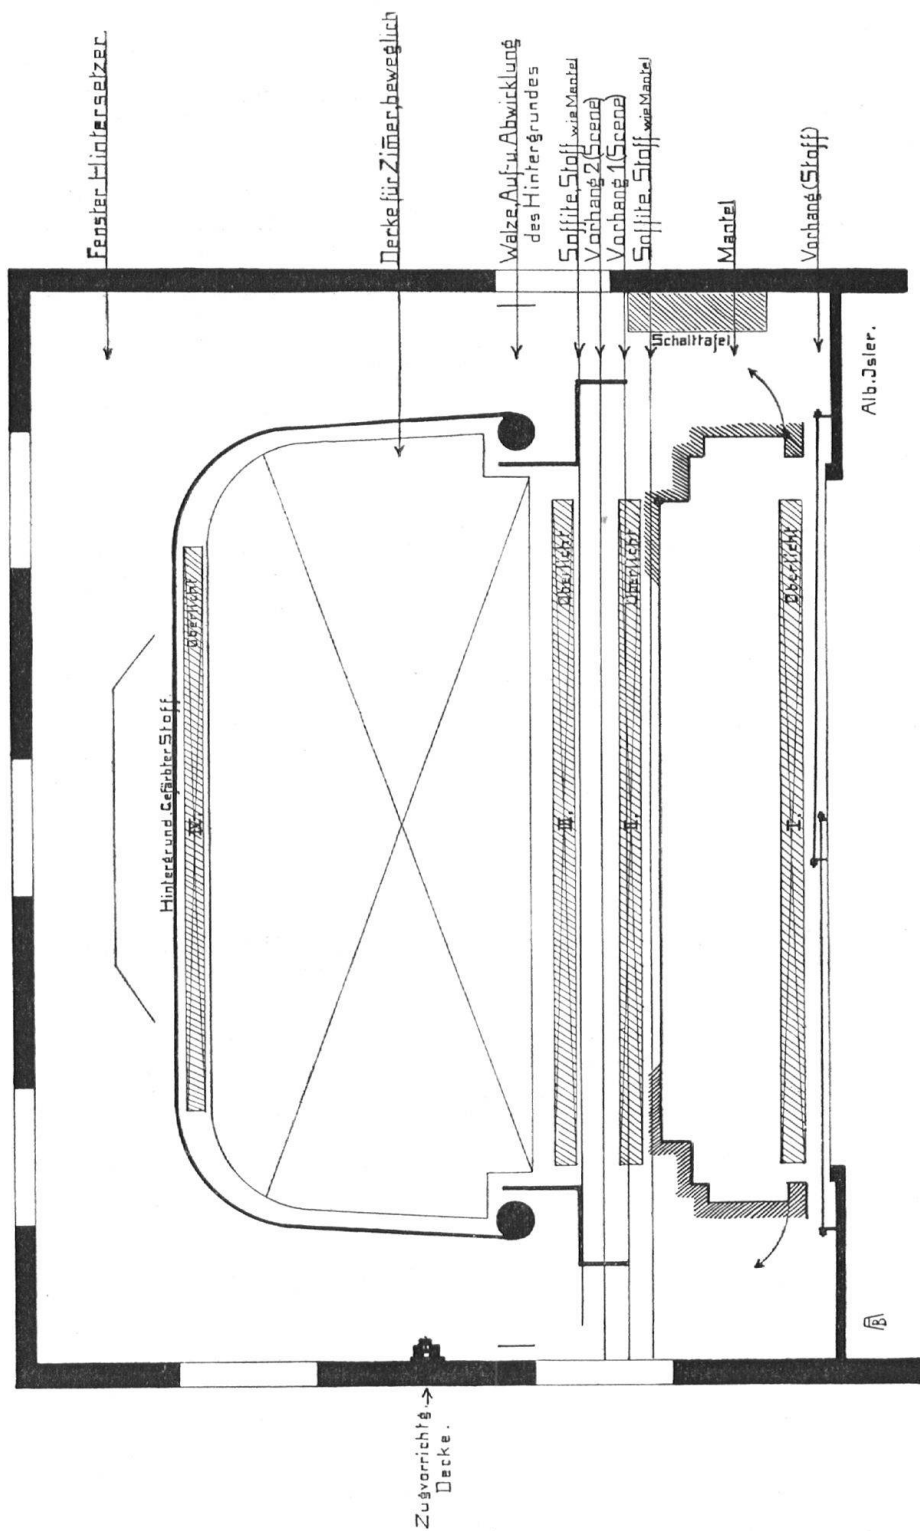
Grundriss der Bühne des Theaters im Rössegarten. Von *Albert Isler*, Zürich
